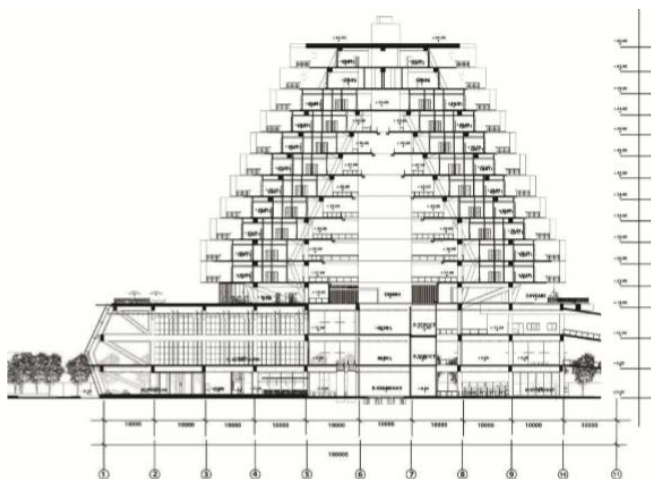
20. Tampak Depan yang Menunjukkan Fasad
